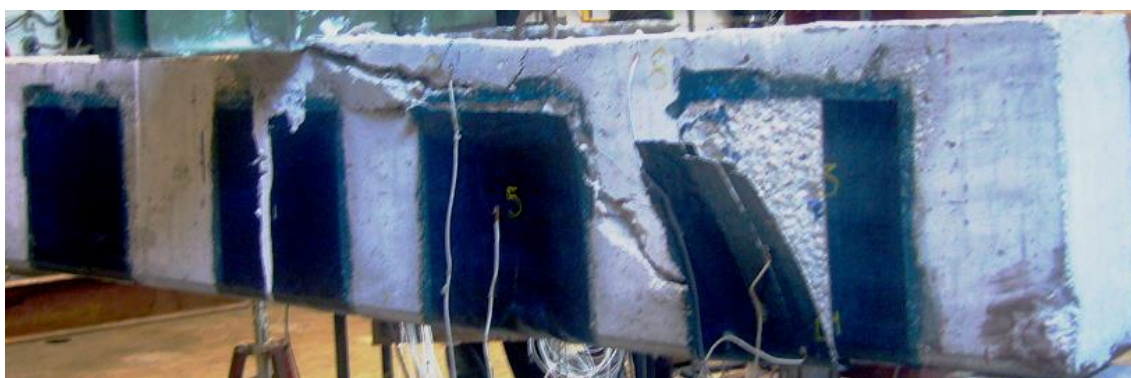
Fallo en vigas con configuración en U a 90° con separación. (Alzate, 2012)
